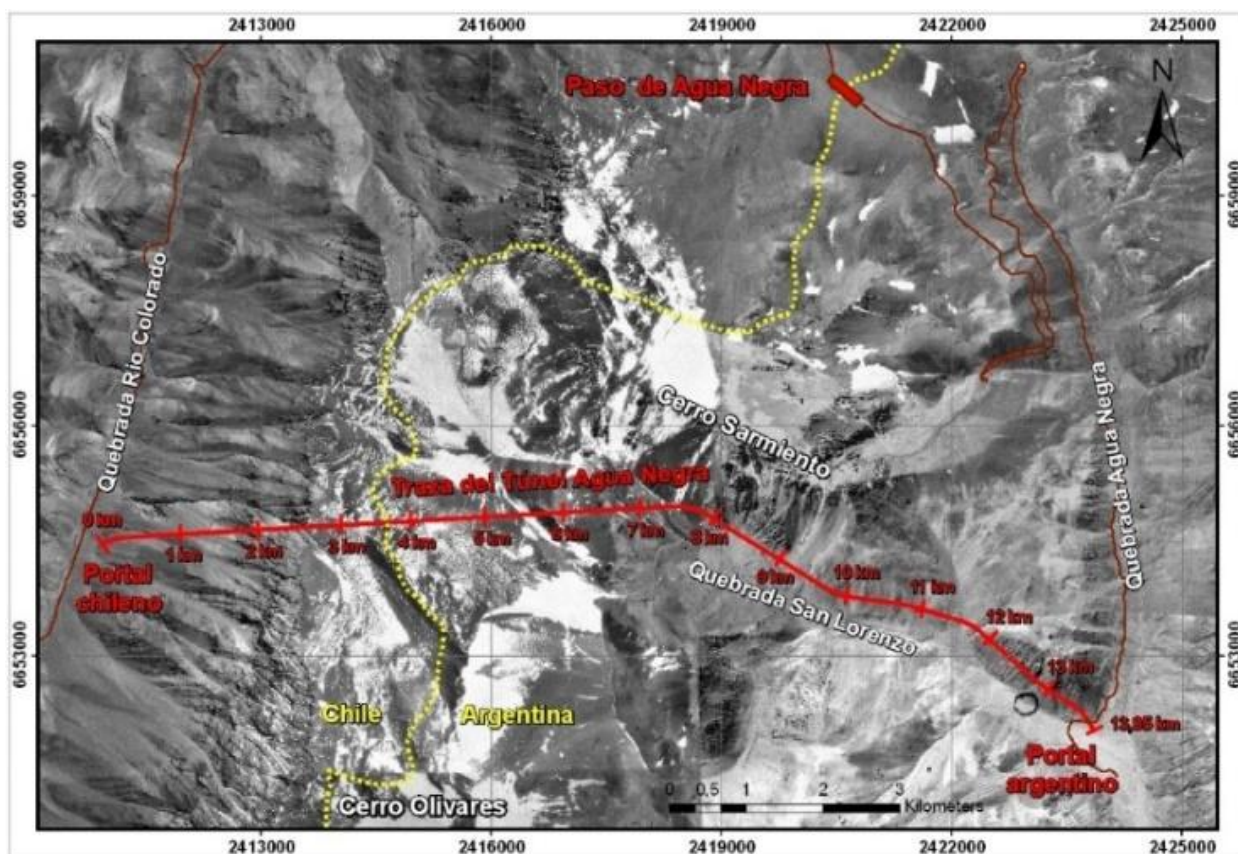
Traza del Proyecto de Ingeniería Básica - TAN
